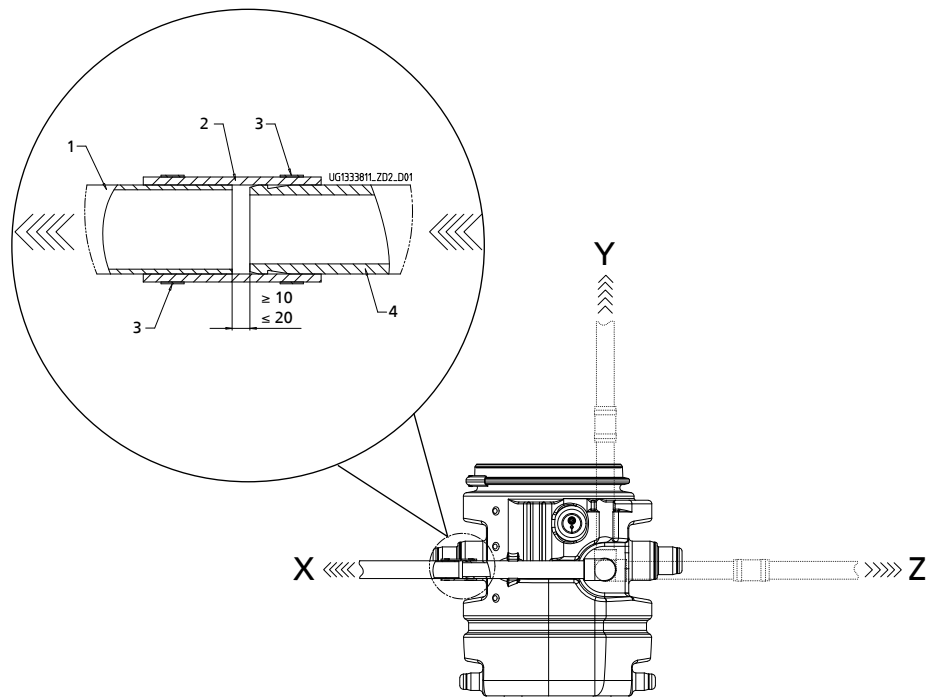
Druckrohr montieren und Einbaumaß einstellen, Abmessungen [mm]
